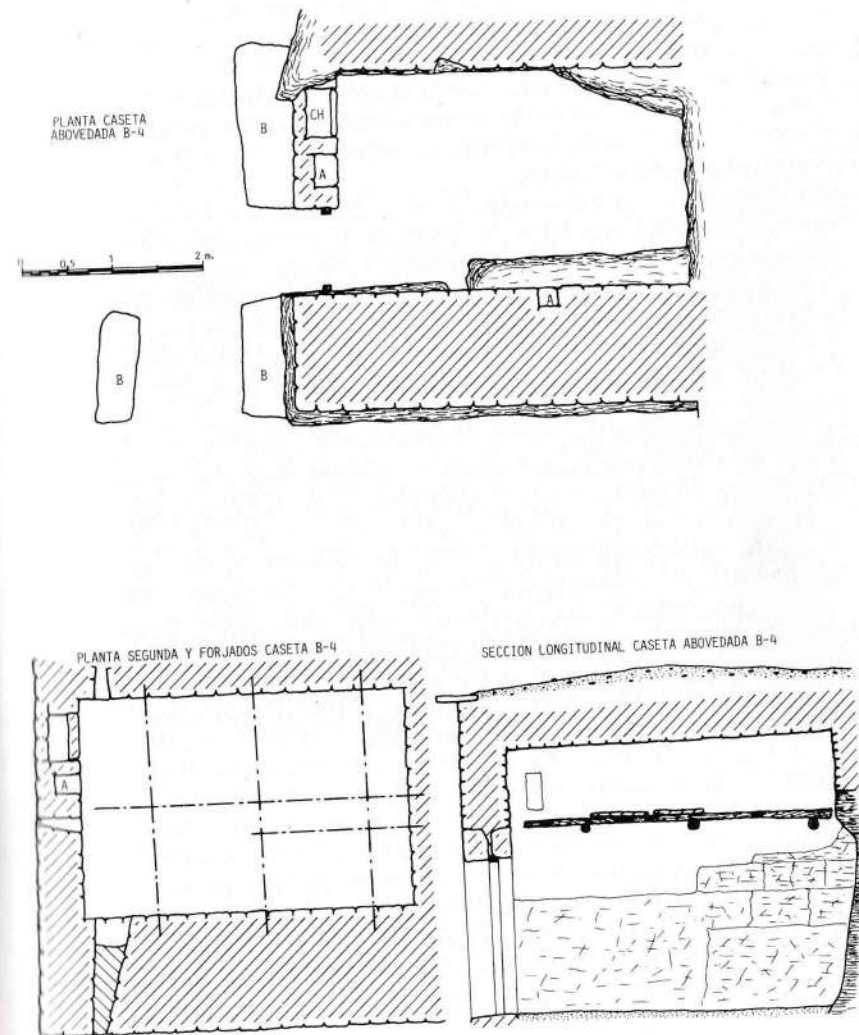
Plantas y sección de la caseta abovedada B-4. En la segunda planta (dibujo inferior izquierdo) se representan los ejes de las vigas del forjado. Abreviaturas similares a las de la Fig. 4.
